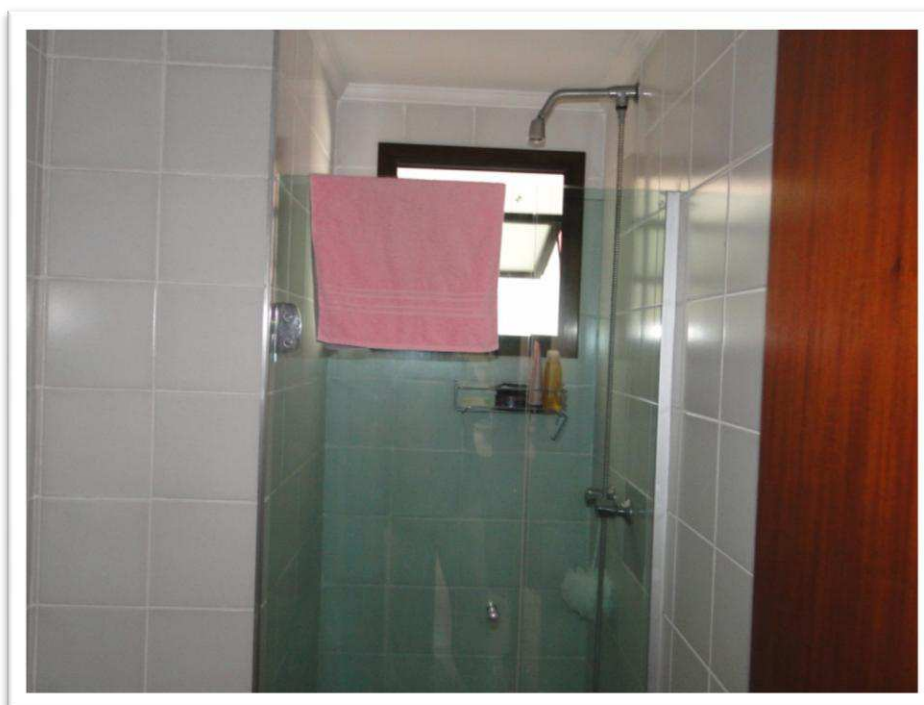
Vista sob outro ângulo do banheiro 1, vendo-se o box do chuveiro.
